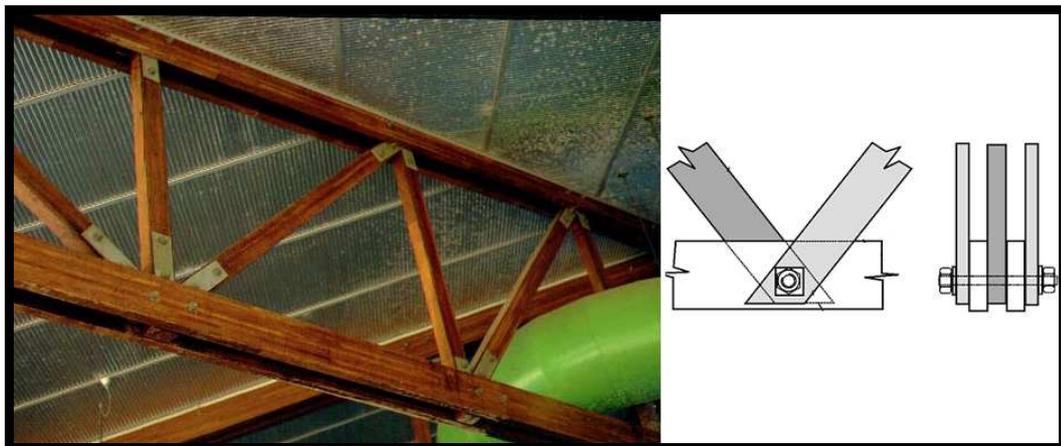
Exemplo de ligações em estruturas articuladas planas
